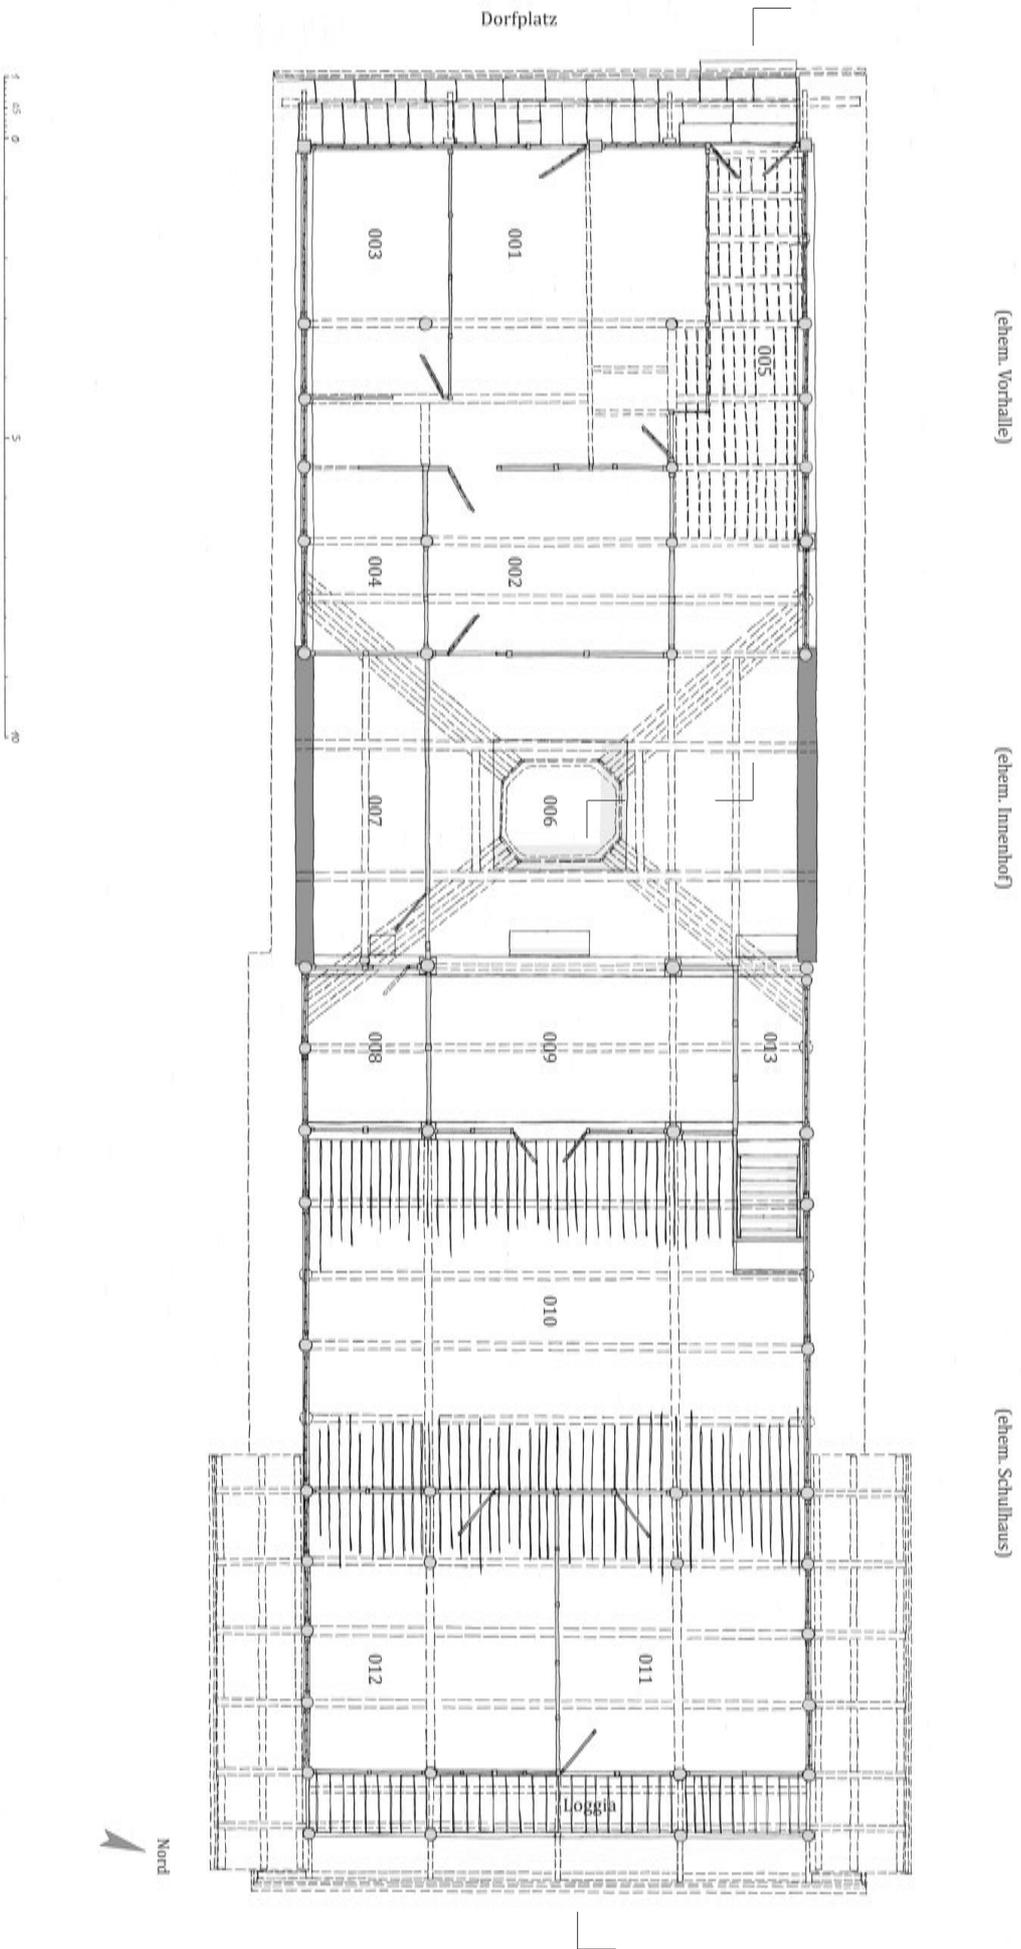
Grundriss Schule (EG), M 1:125
